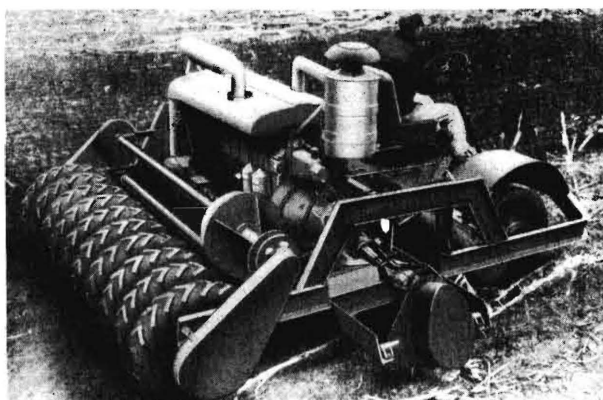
Amerikanische Fräsmaschine „Landmaster“. Motorleistung 180 PS, Schnittbreite 2,40 m, größte Schnitttiefe 18 cm
